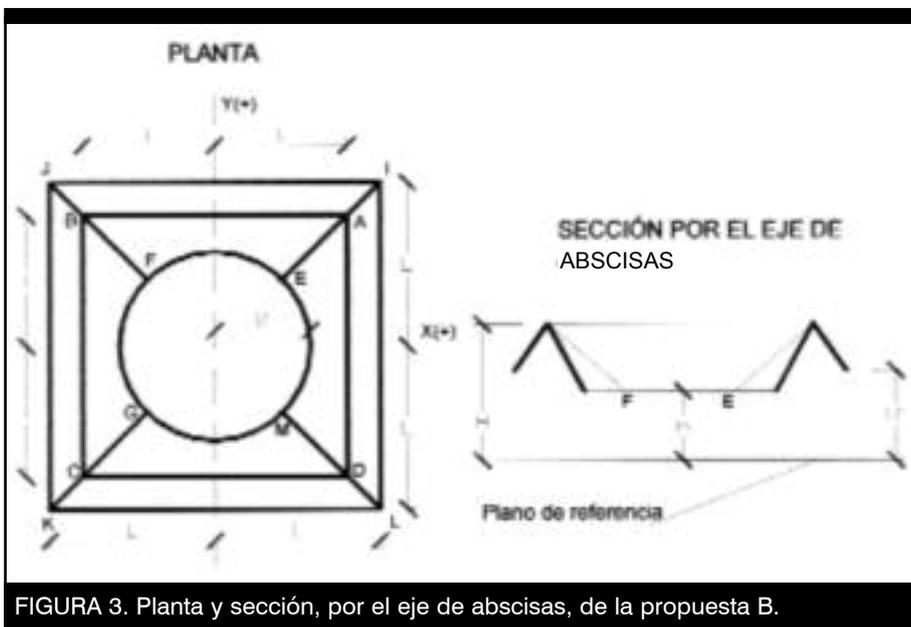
Planta y sección, por el eje de abscisas, de la propuesta B.
